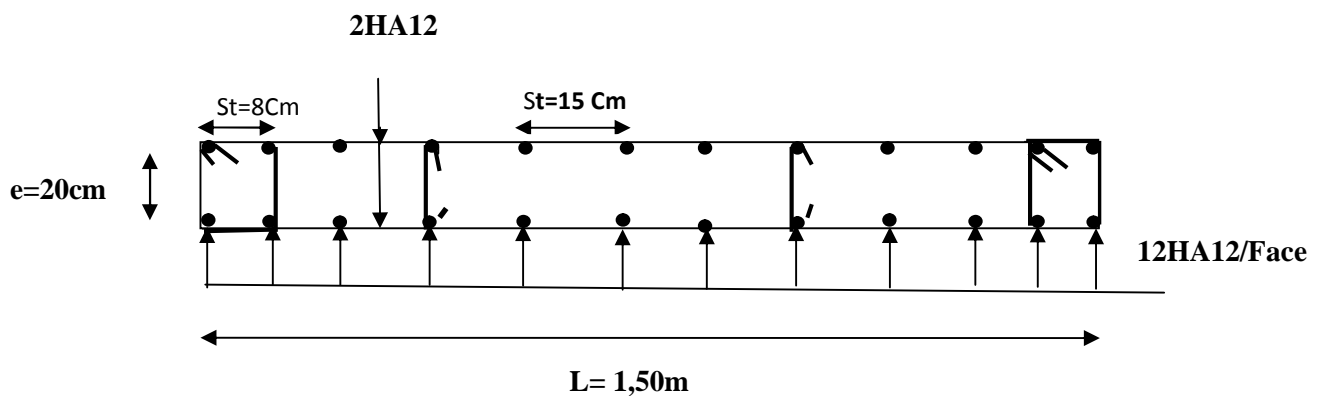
schéma de ferrailage d'un voile (Vy2)
